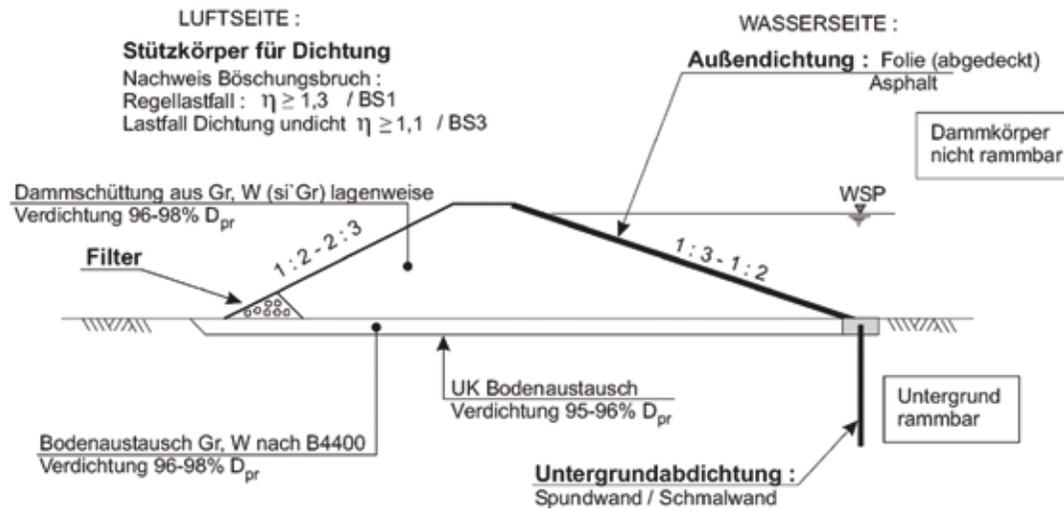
Bautyp – Damm Oberflächenabdichtung (Folie/Asphalt), Untergrundabdichtung: Spund- bzw. Schmalwand wasserseitig
